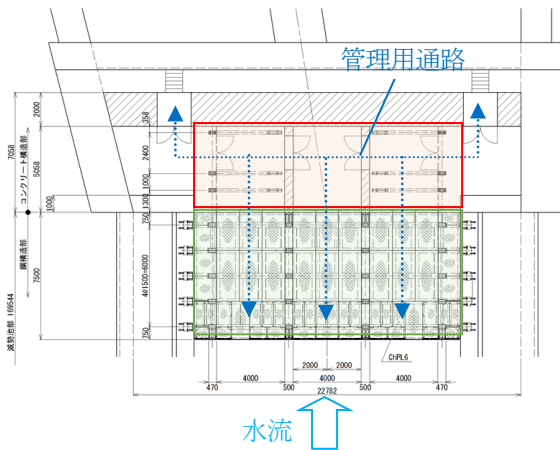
消音管の平面図 (赤：コンクリート構造部，緑：鋼構造部)
